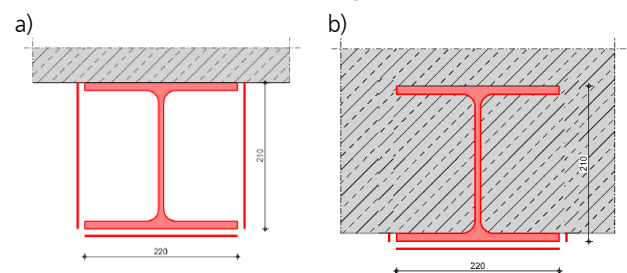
a) Brandfall – Querschnitt mit dreiseitiger Beanspruchung
